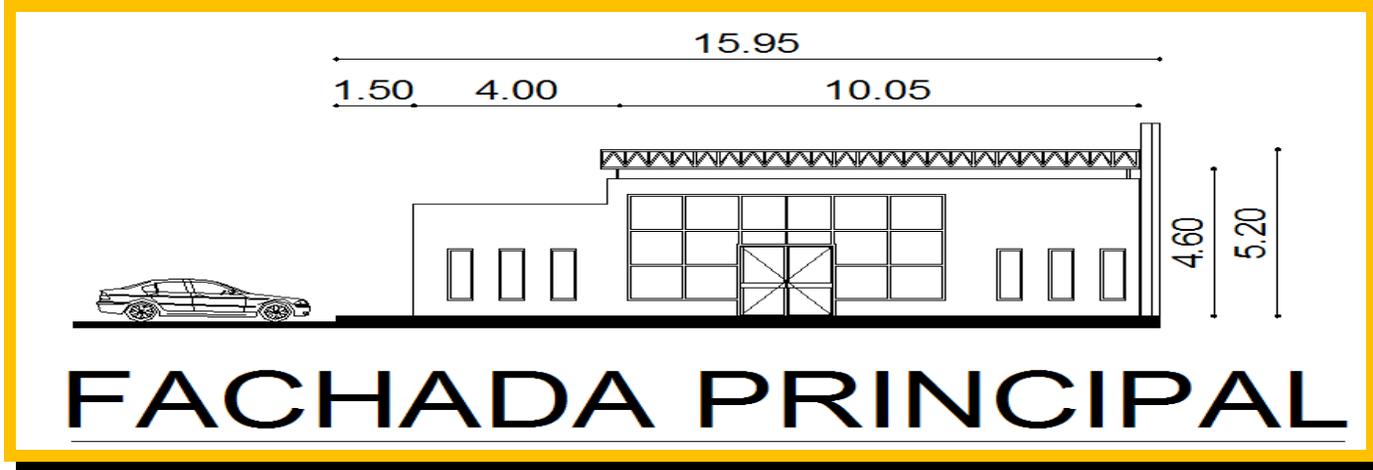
(fachada principal-u.h. Emiliano Zapata)
